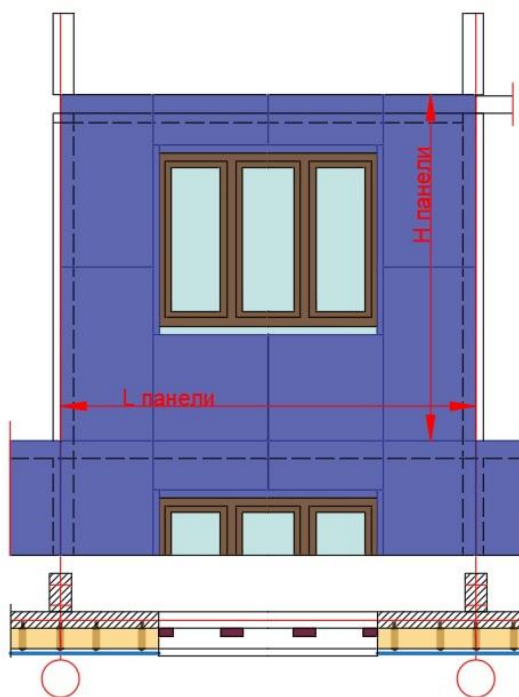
Схема размещения вентфасадных панелей на фрагменте типового этажа панельного дома
